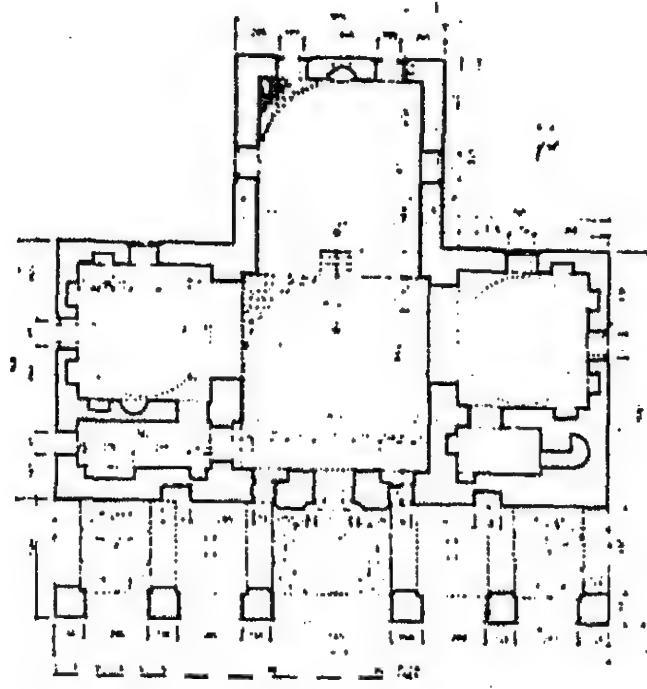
مسقط أفقي لمسجد الآجا (عمارت) إسحاق بك في أسكوب
